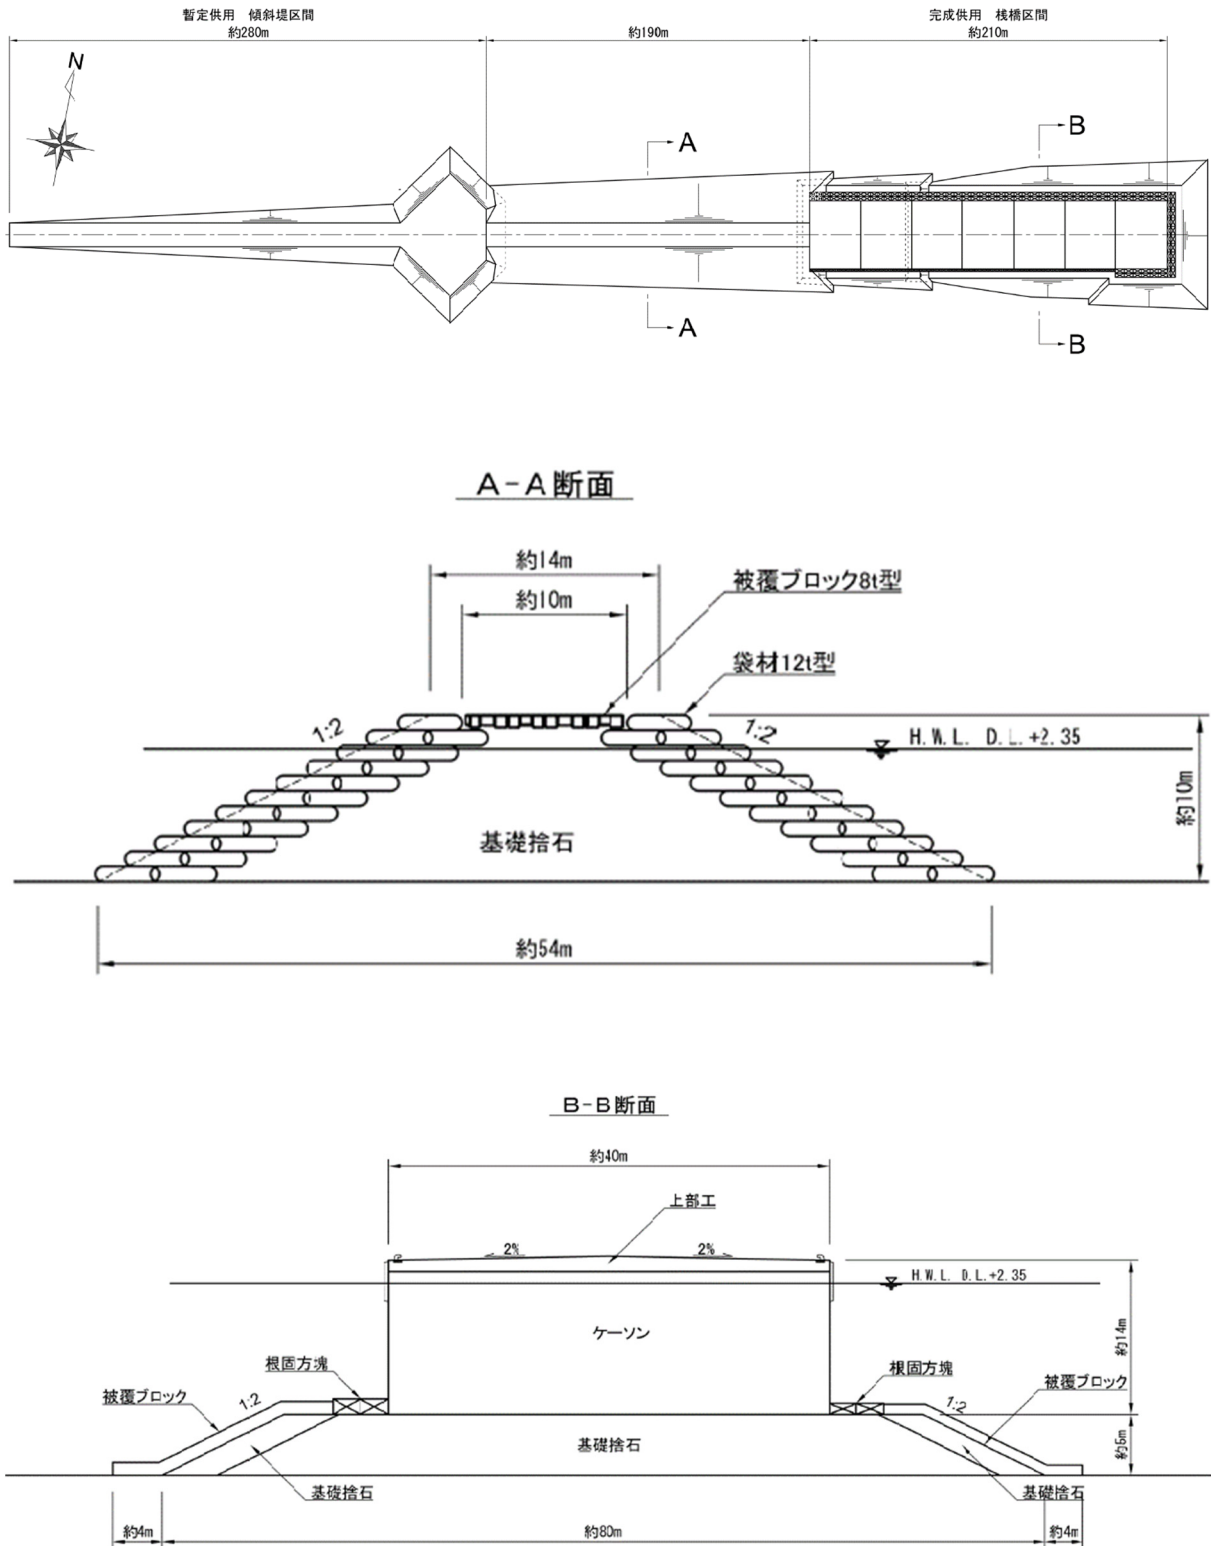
(3) 仮設栈橋の平面図及び標準断面
